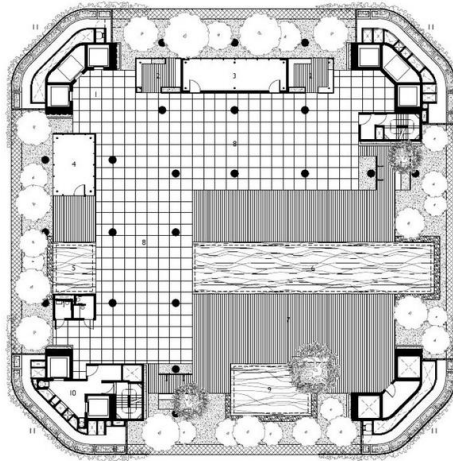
Denah Lantai 1 Oasia Hotel Singapura
